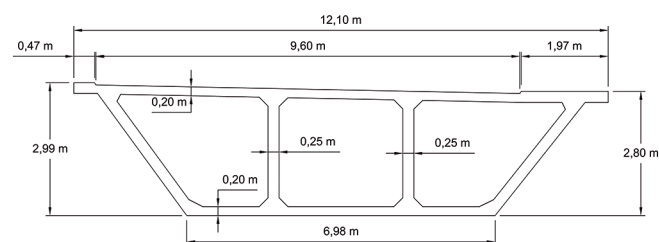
Sección transversal de viga cajón del puente sobre el río Tenorio.
